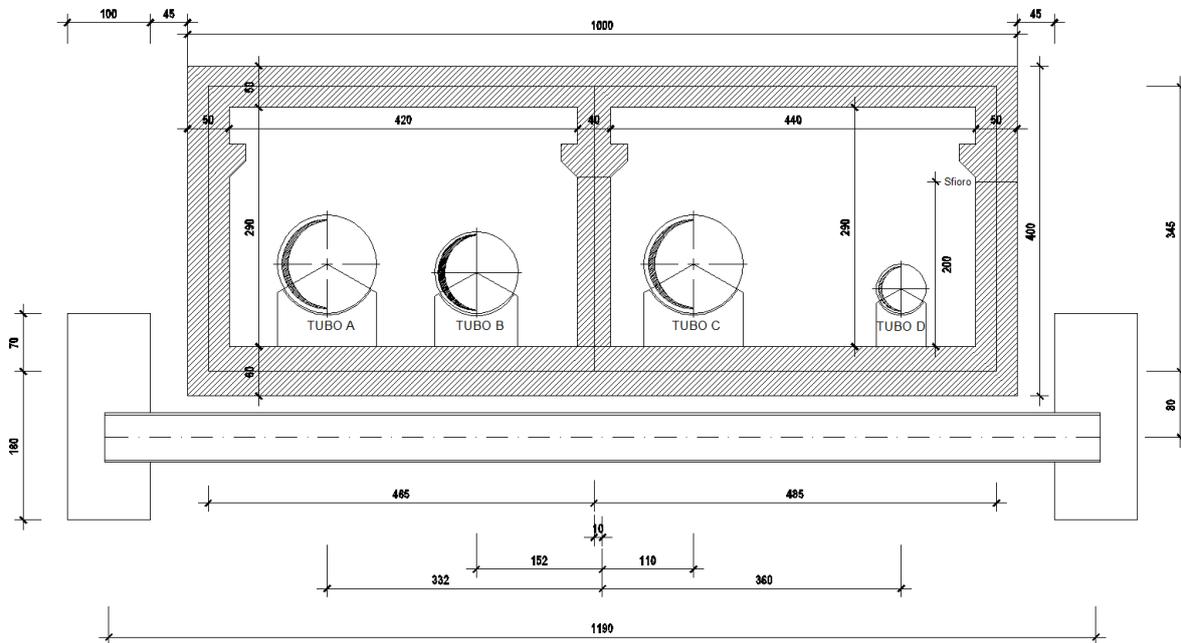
Geometria struttura esistente – Sezione trasversale di dettaglio
